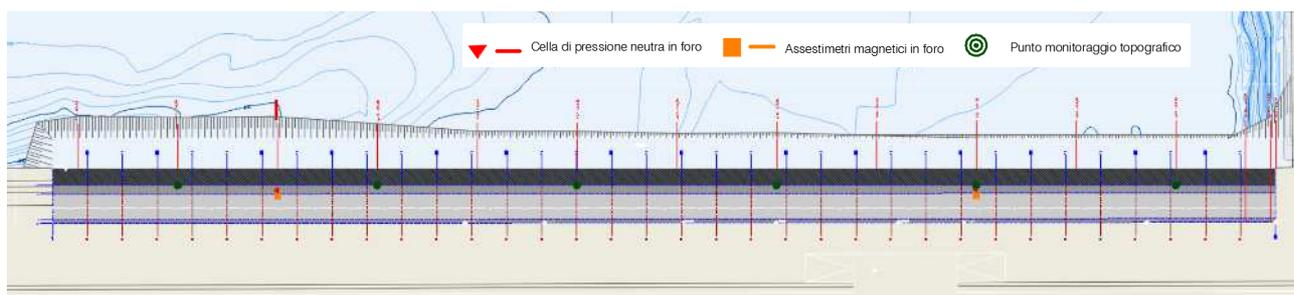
Planimetria banchina turistica con indicazione delle verticali di monitoraggio
